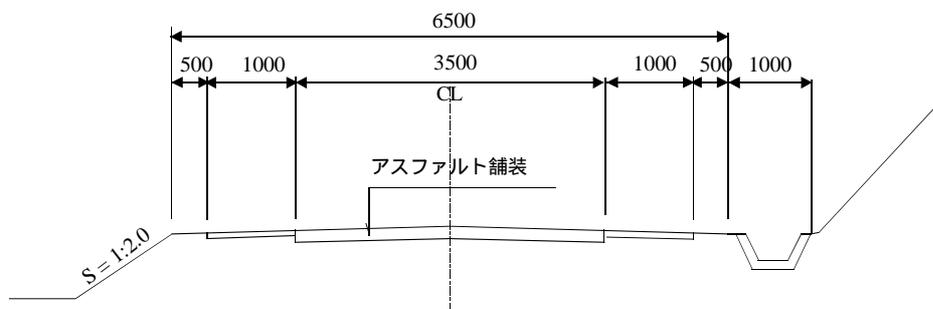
道路等級 V（国道 15A）の土工部幅員
